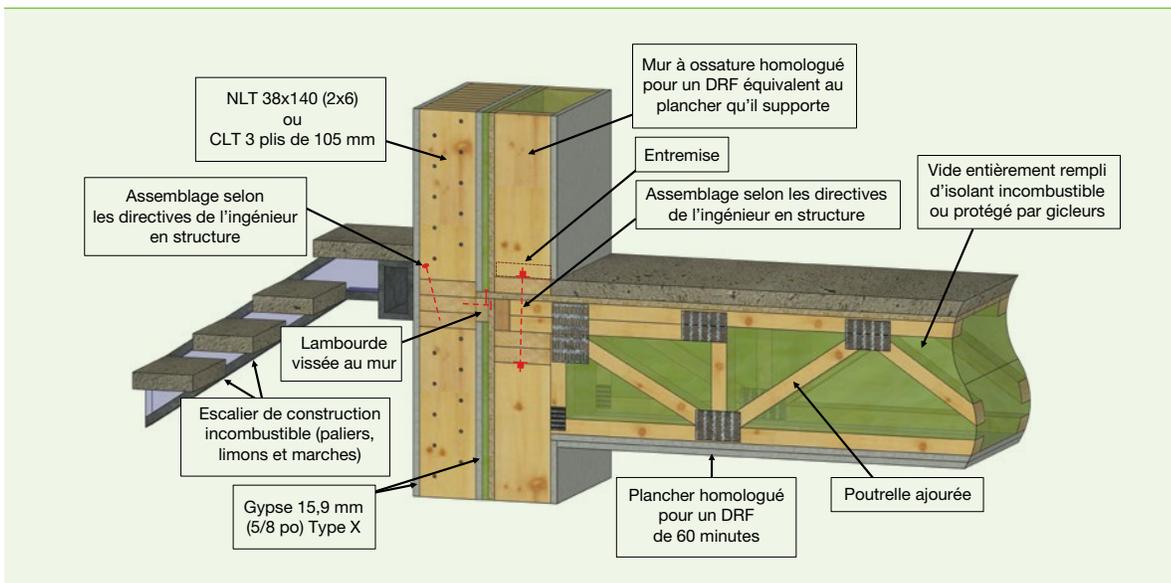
• Détail de jonction mur/poutrelle ajourée appuyée par la membrure supérieure
